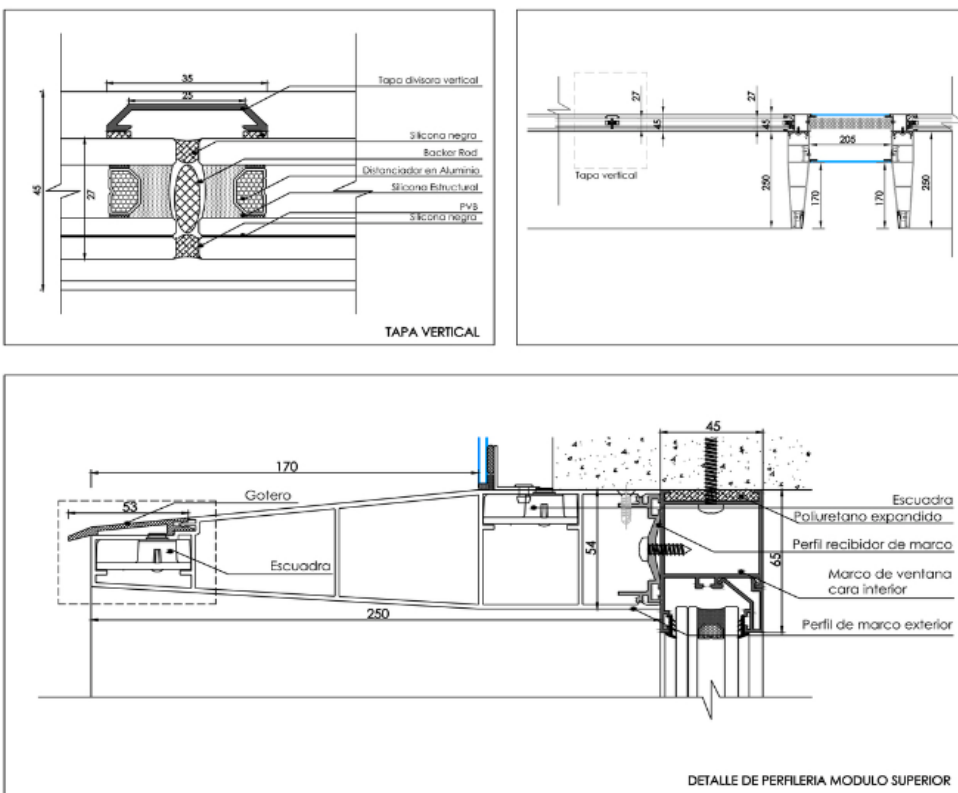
Sistema estructural fachada. Tomado de: Constructora Sestral, 1987, p.1.
